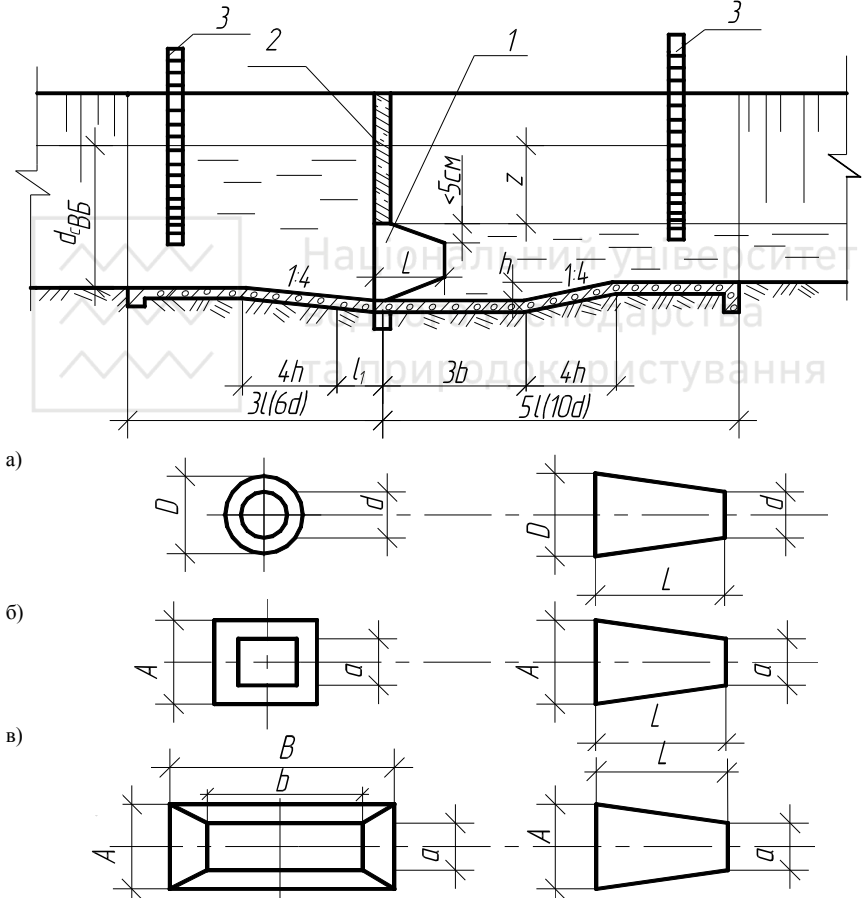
Схема установки водомірної насадки та їх типи:
